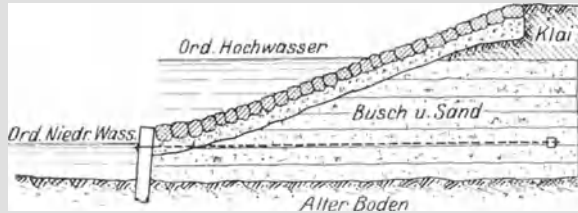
Deckwerk Bremerhaven. Maßstab 1 : 300.
